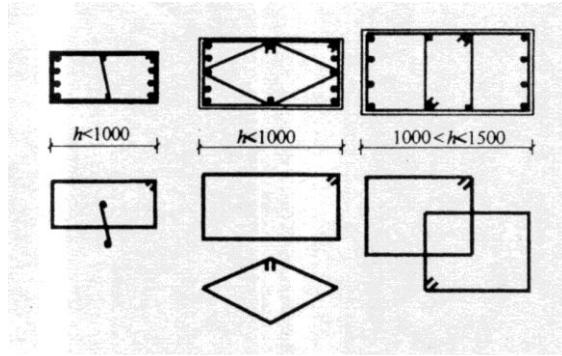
偏心受压柱的纵向构造钢筋与复合箍筋
